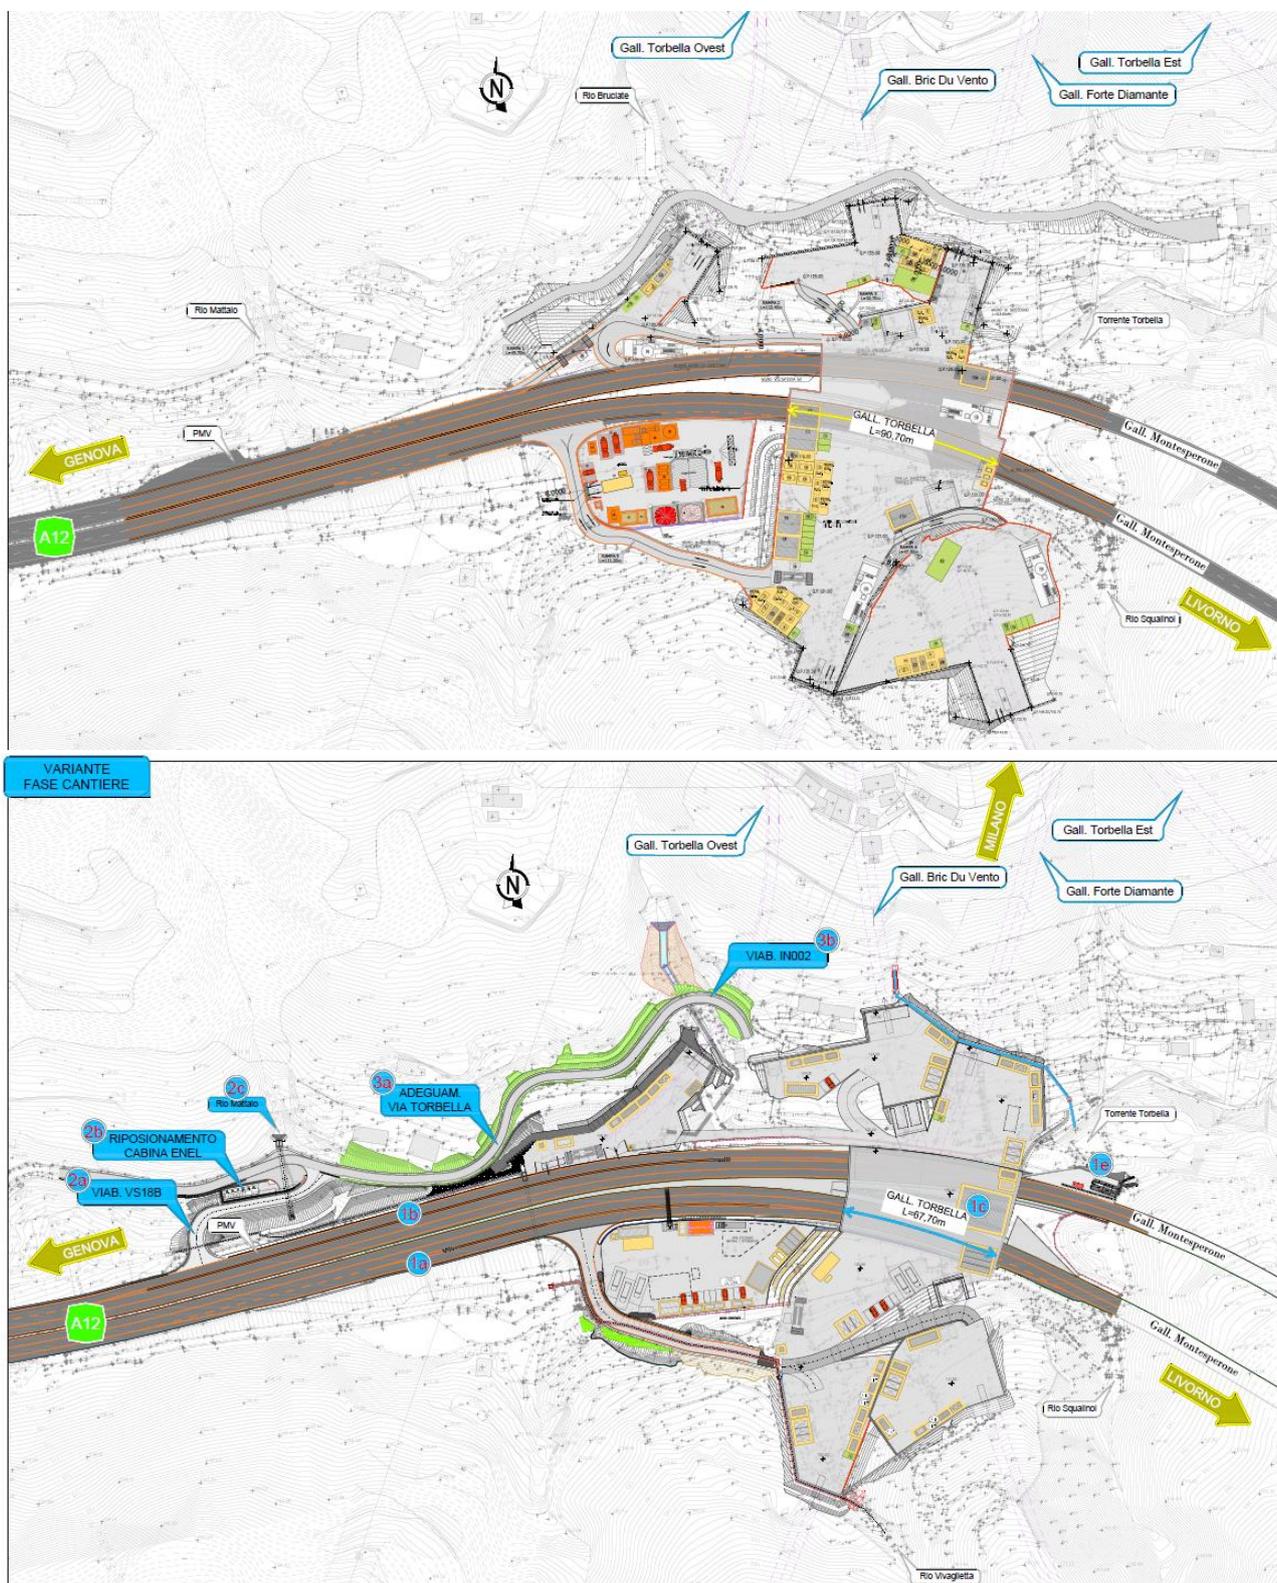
Confronto tra area di cantiere sottoposta a V.I.A. (in alto) e l'area di cantiere con le modifiche oggetto della presente Valutazione Preliminare. Fonte tavola "raffronto tra progetto definitivo e progetto di variante Fase di cantiere" allegata alla Lista di controllo.
